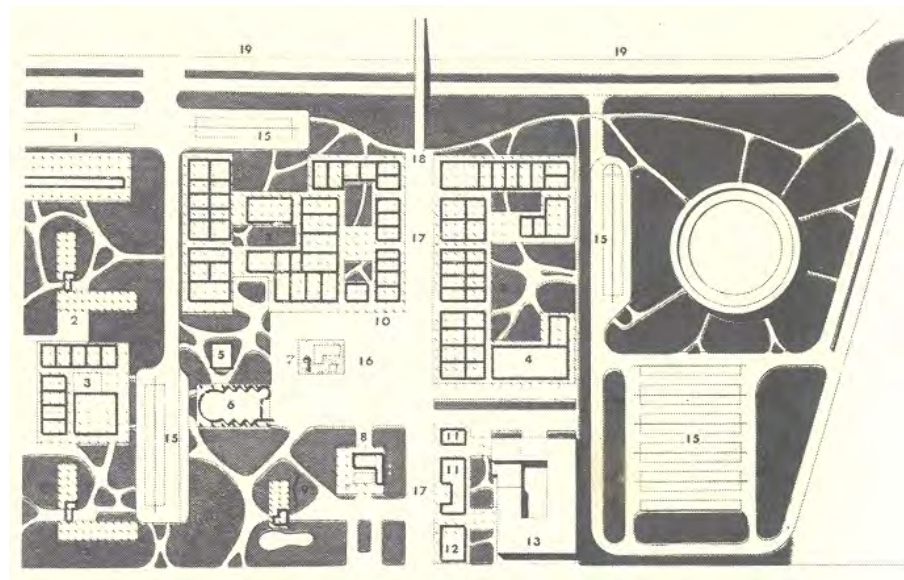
Centro Cívico, Plan Piloto de Chimbote.
